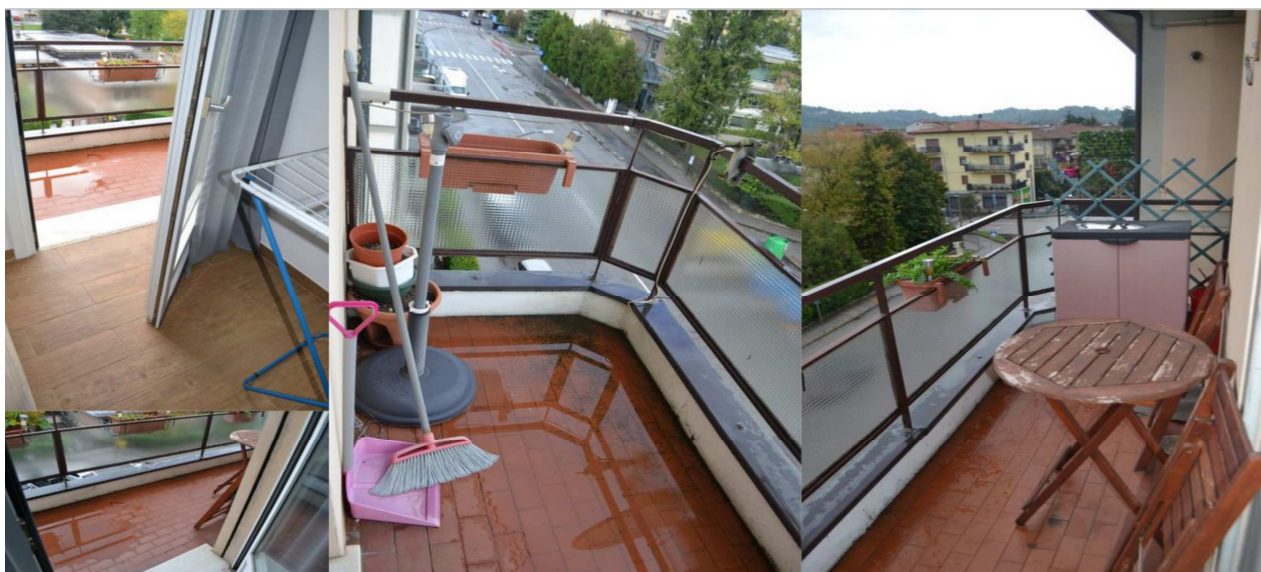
Terrazza esterna pavimentata con listoncini in cotto
